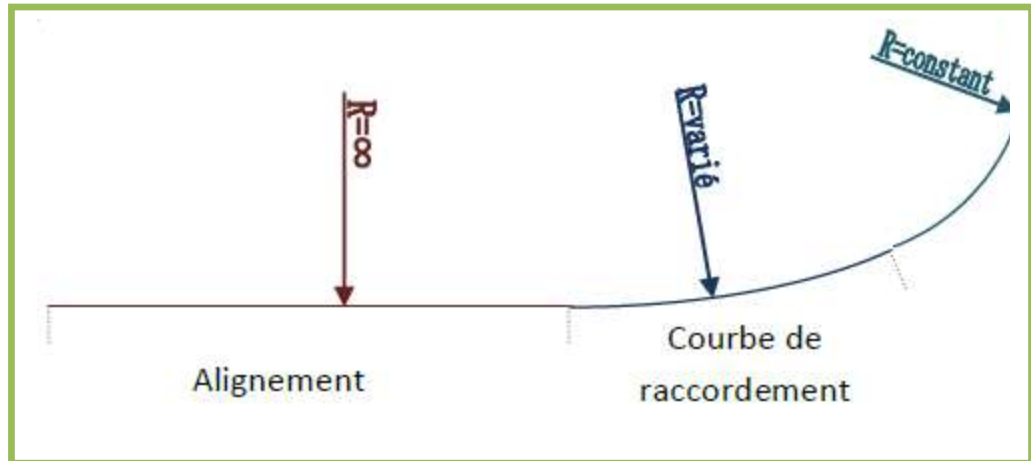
LES ELEMENTS DU TRACE EN PLAN
